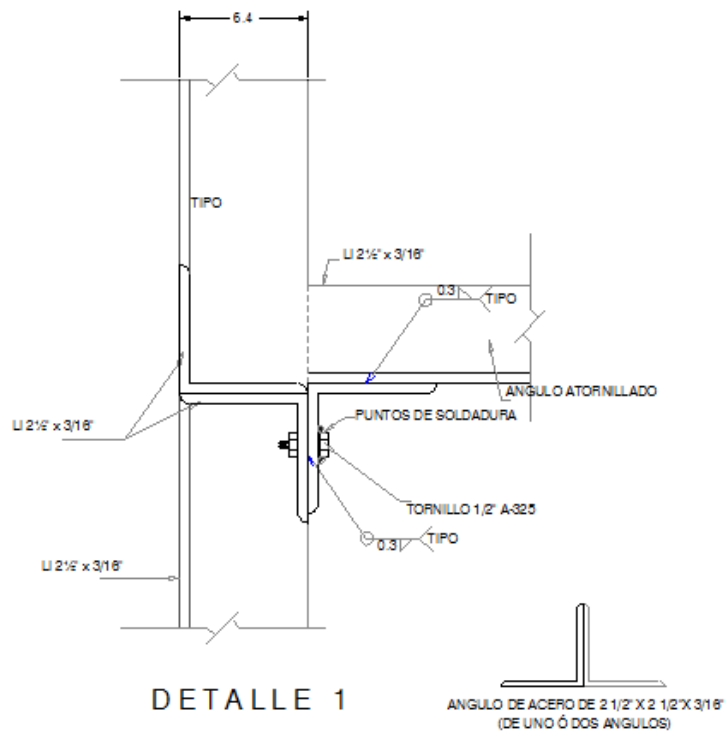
Detalle fijación de soporte para tabletas de policoncreto con estructura metálica
